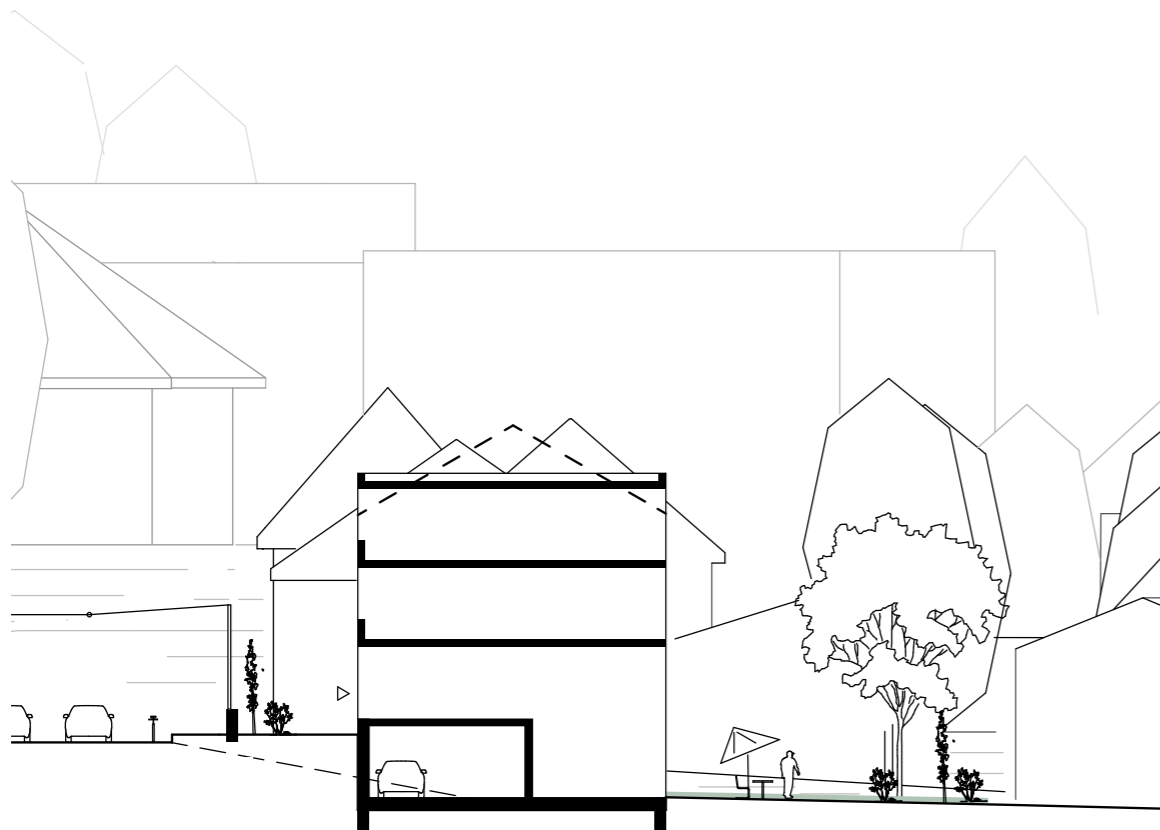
Ausschnitt Schnitt, Masterplan, GWJ
